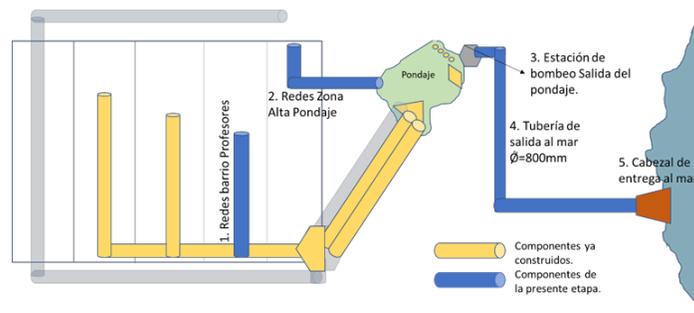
Esquema del componente alcantarillado pluvial SAI ETAPA 2.
